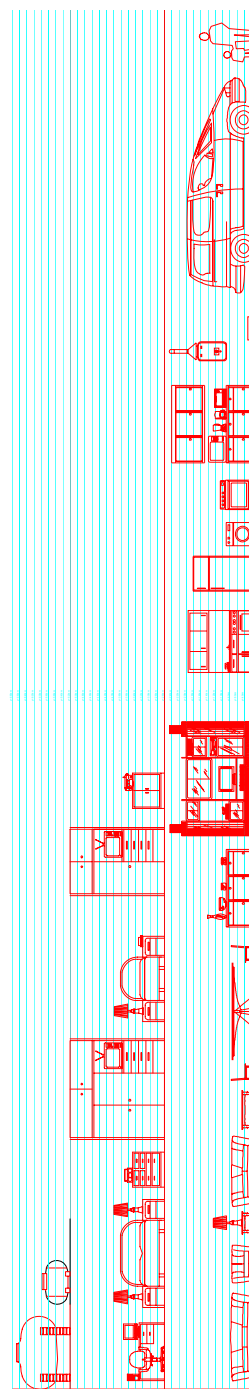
Menaje para la vivienda tipo V (dos plantas)
